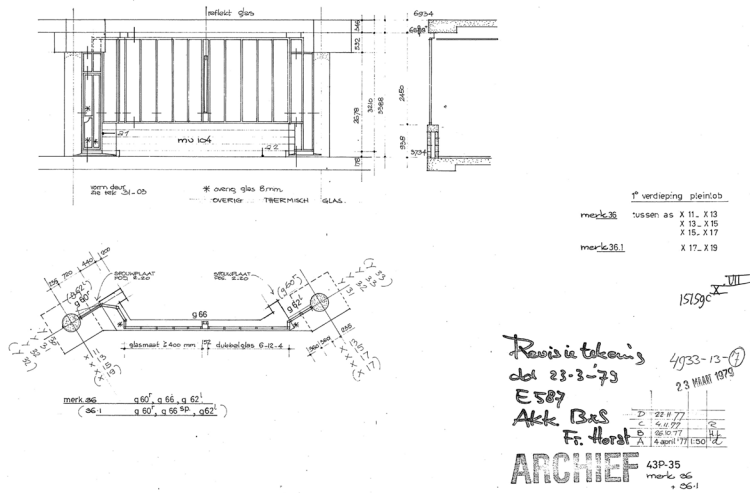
Uno de los más de cien elementos de fachada diferentes. Alzado, planta y perfil. 1979.
